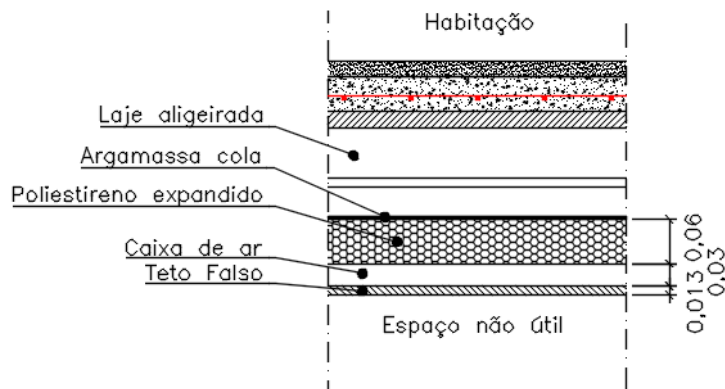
Pormenor construtivo como proposta de intervenção para laje de pavimento em contacto com espaço não útil
